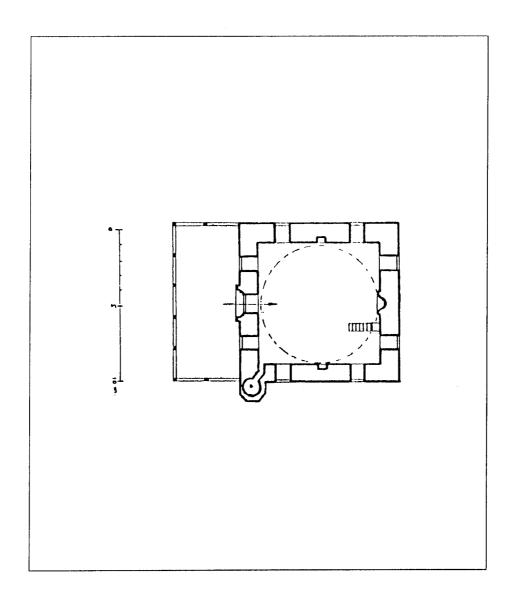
مكرر) مسقط أفقي لمسجد السوق في برلبه (عن : كيل) .
